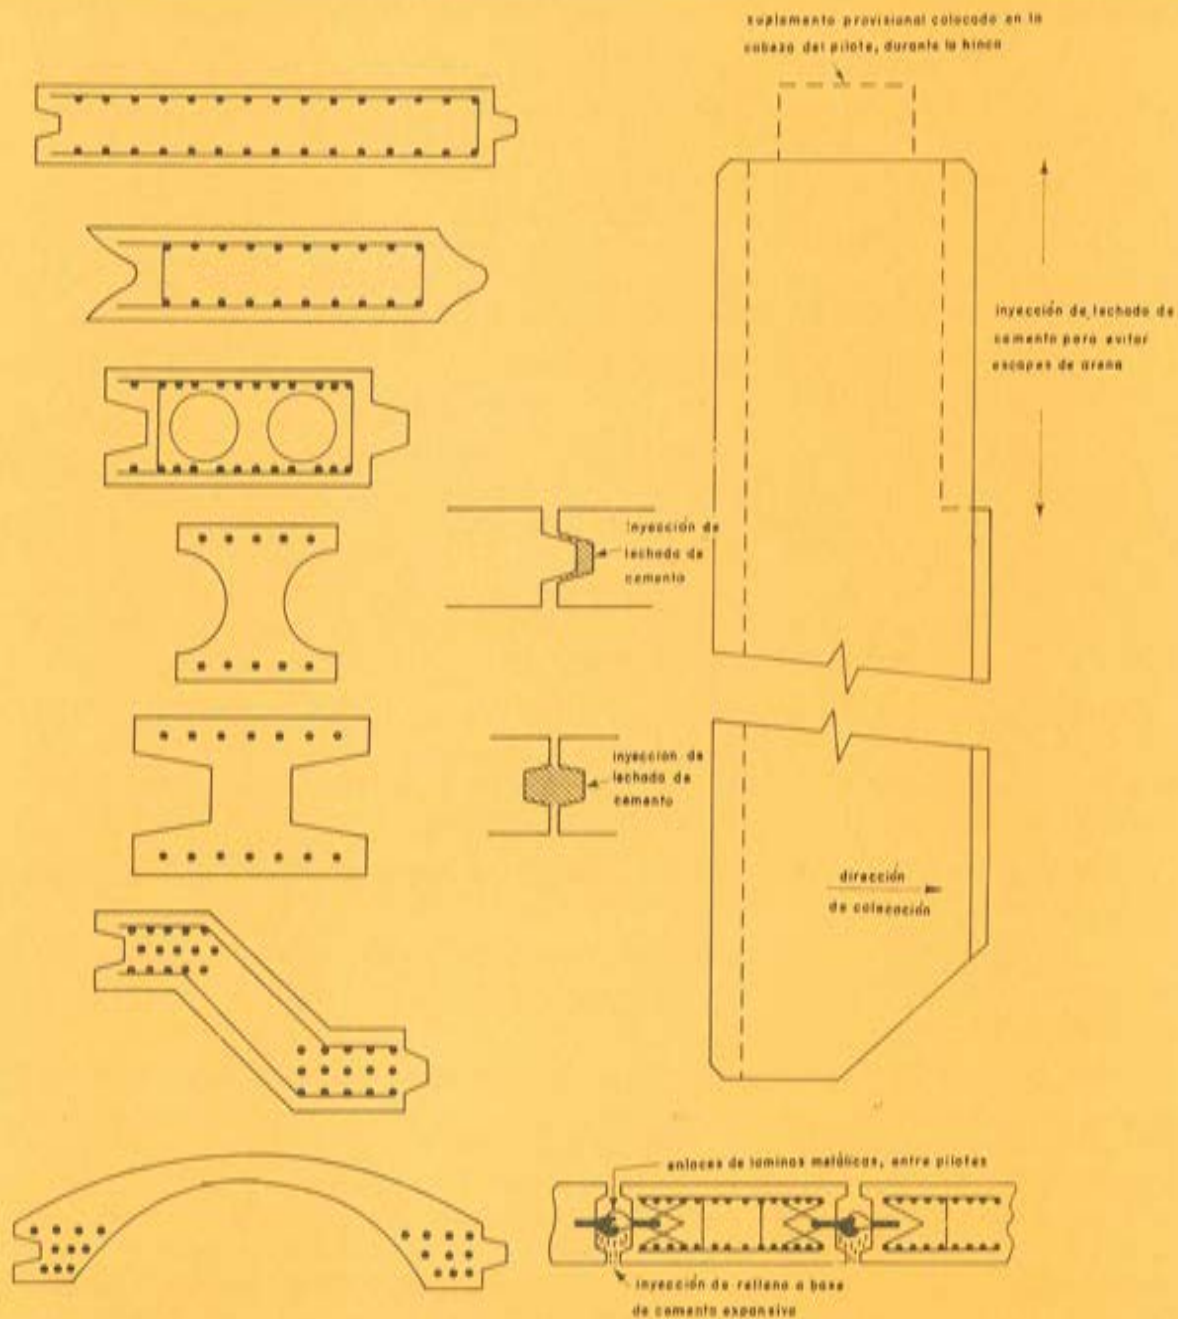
Detalles y secciones transversales típicas de las tablestacas de hormigón pretensado.
